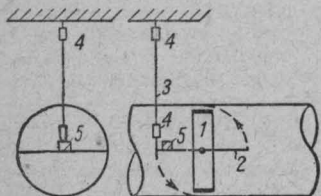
Автоматически закрывающаяся заслонка (поворачивающаяся).
